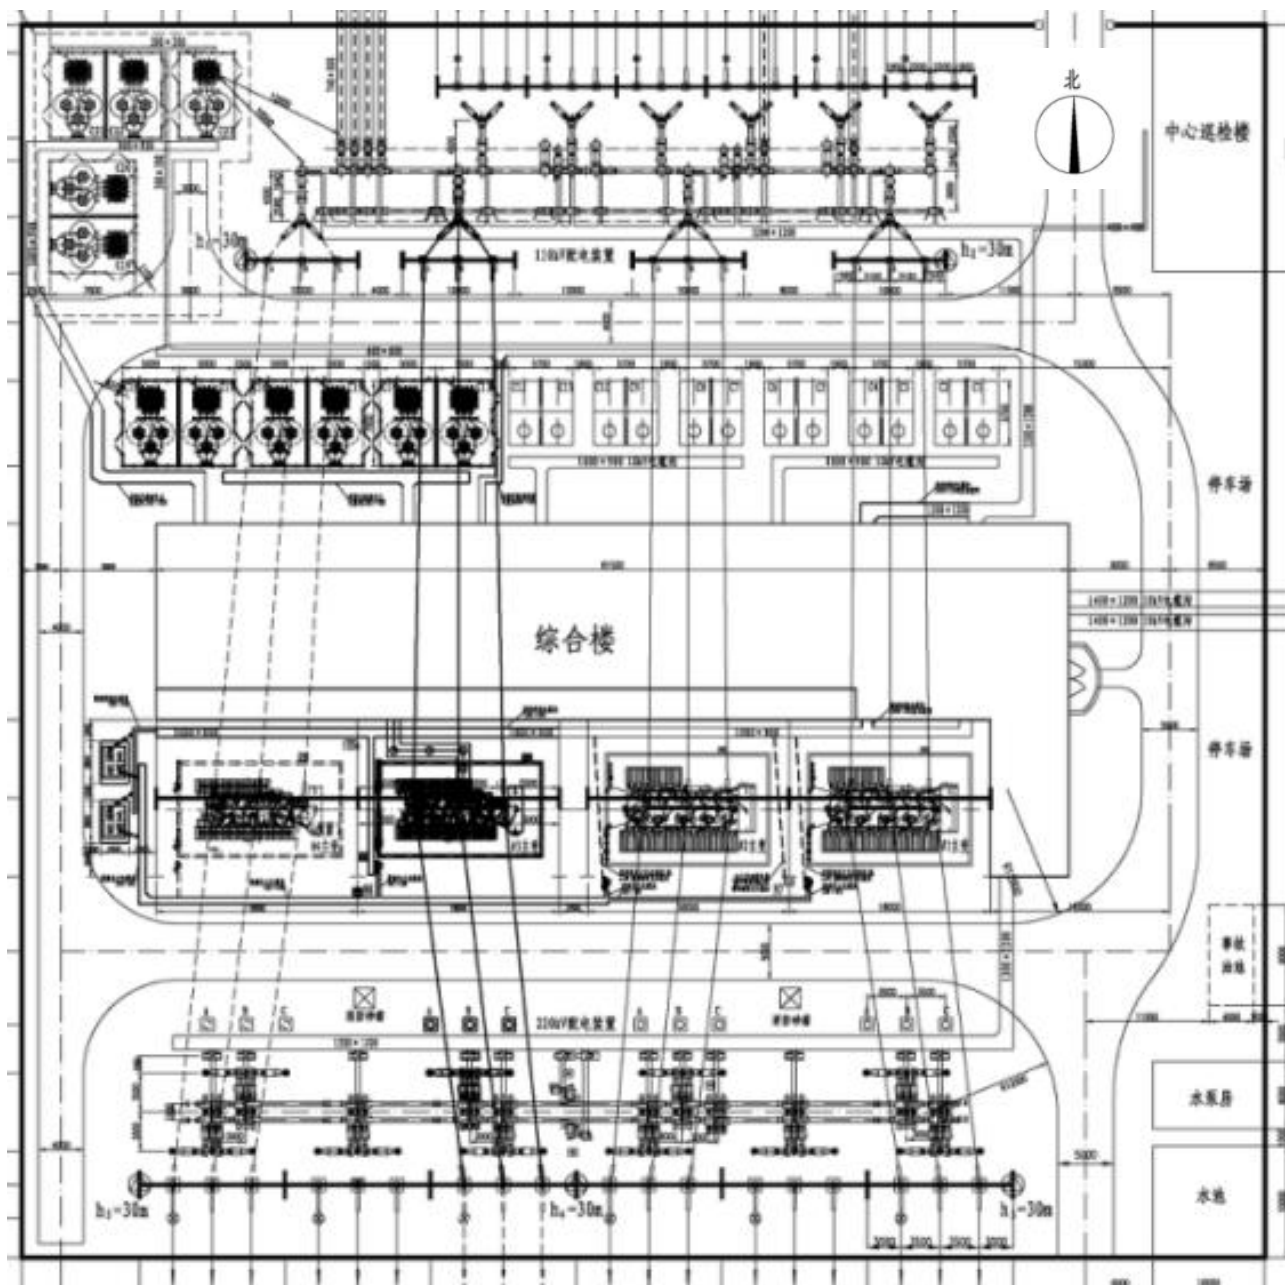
220kV 湾畔站总平面布置示意图（扩建后）
